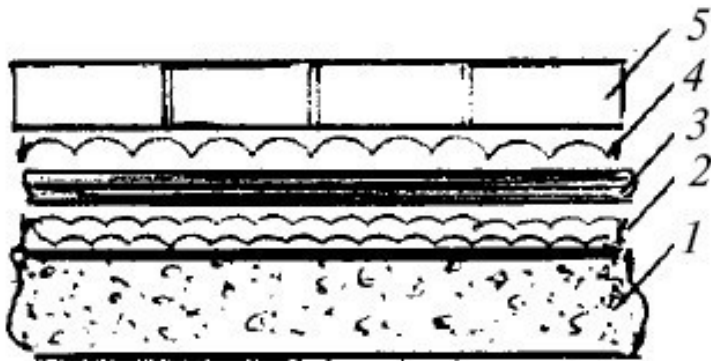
Гидроизоляция пола при высокой влажности помещений: 1 – бетонное основание; 2 – мастика; 3 – гидроизоляционный материал; 4 – раствор для плитки; 5 – плитка
